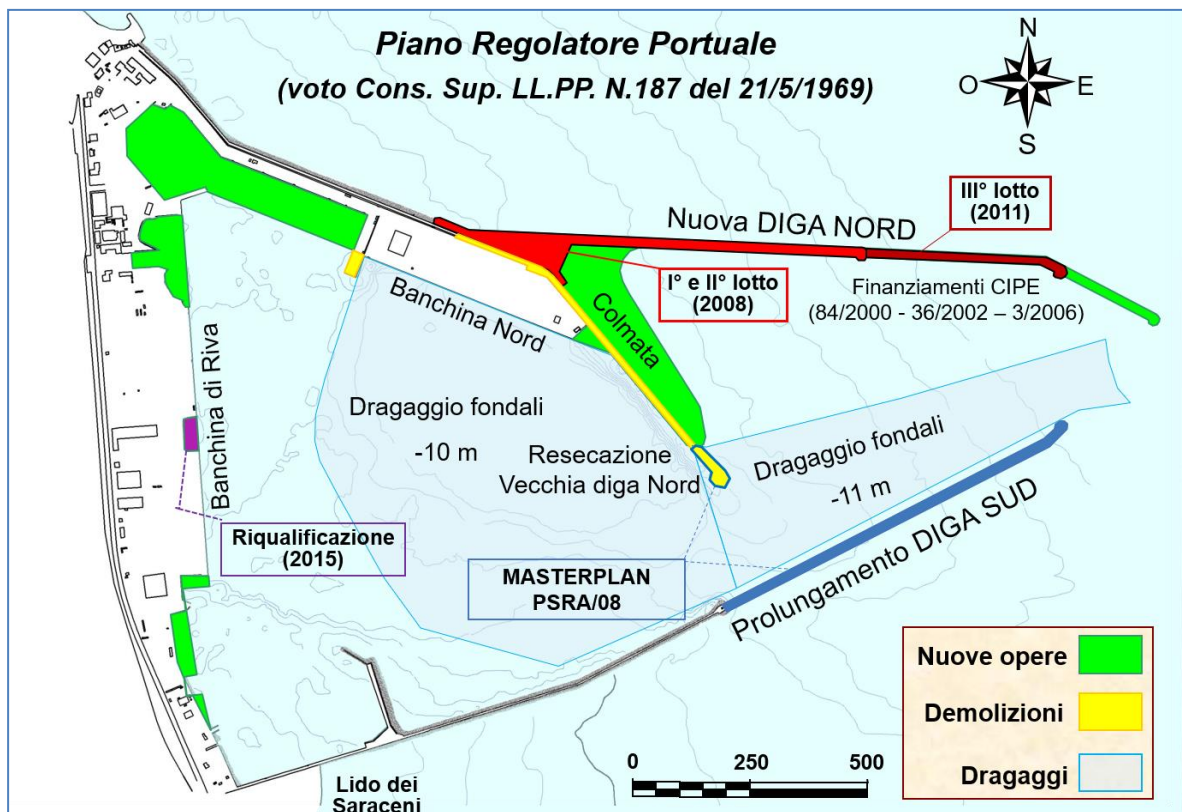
Piano Regolatore Portuale vigente con evidenziazione delle opere già attuate o in fase di attuazione
